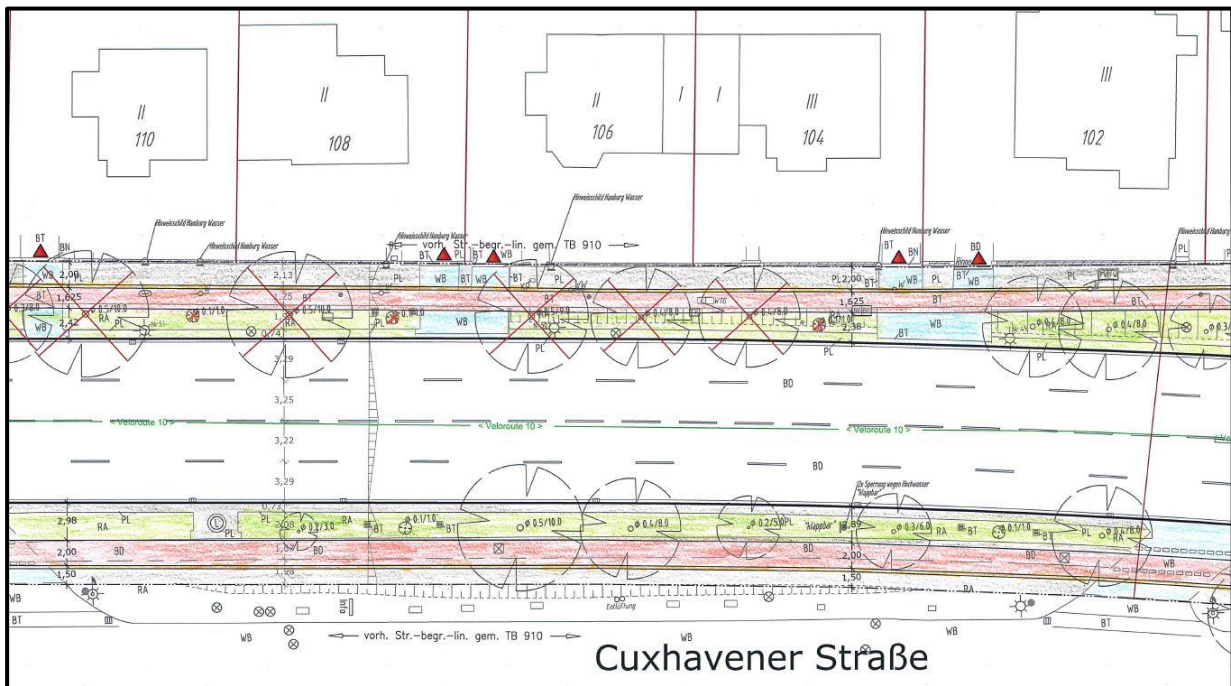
Variante 3: Radweg mit Mindestbreite in den Nebenflächen - Cuxhavener Straße
